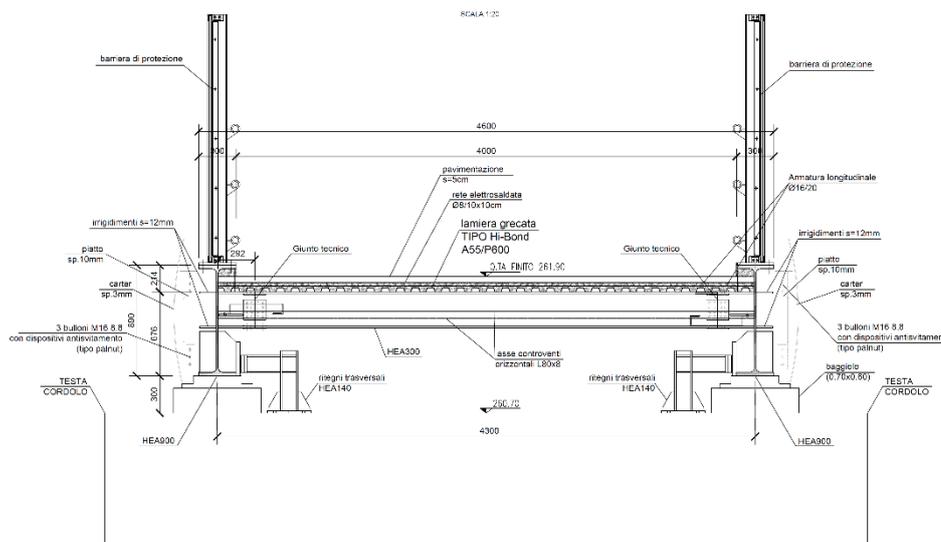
Passerella pedonale nella stazione di Ellera: sezione trasversale
